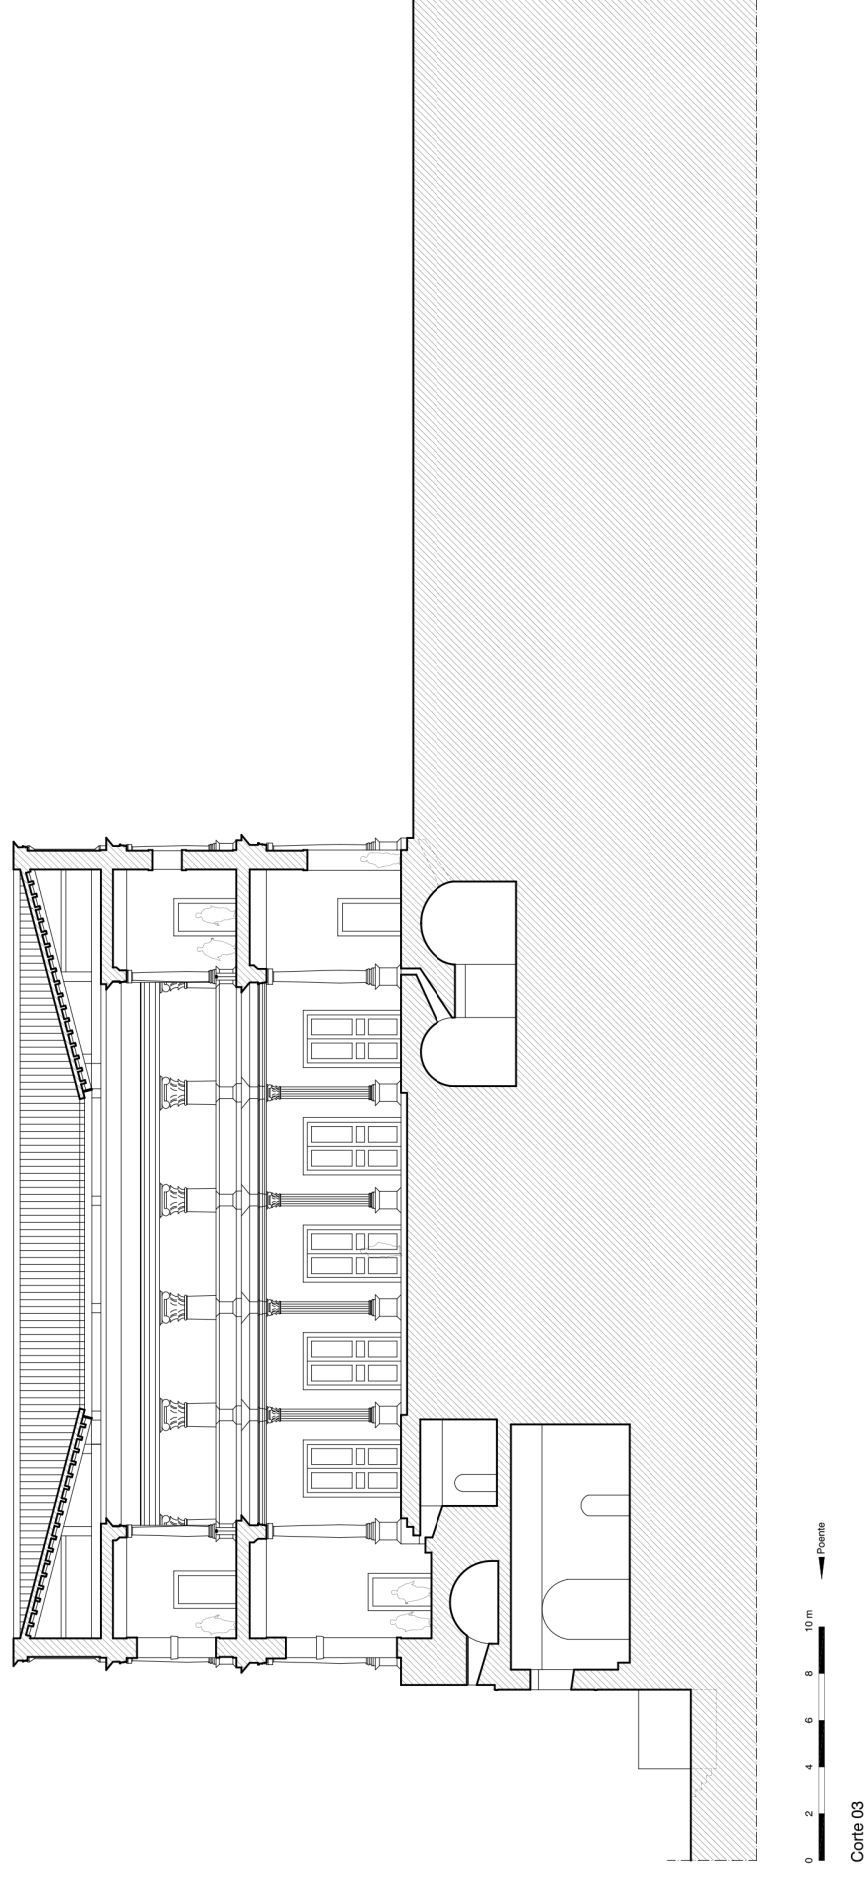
Corte do fórum e do criptopórtico. Ao centro e ao fundo, a fachada da basílica (desenho de Paulo Barreiras).
